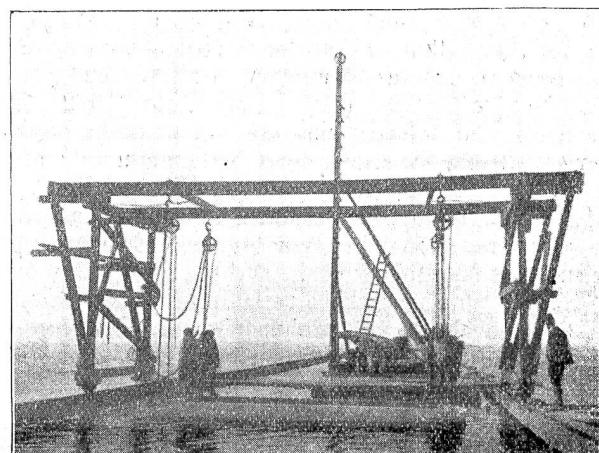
Laufkran mit Betonelement, vor dem Absenken.
